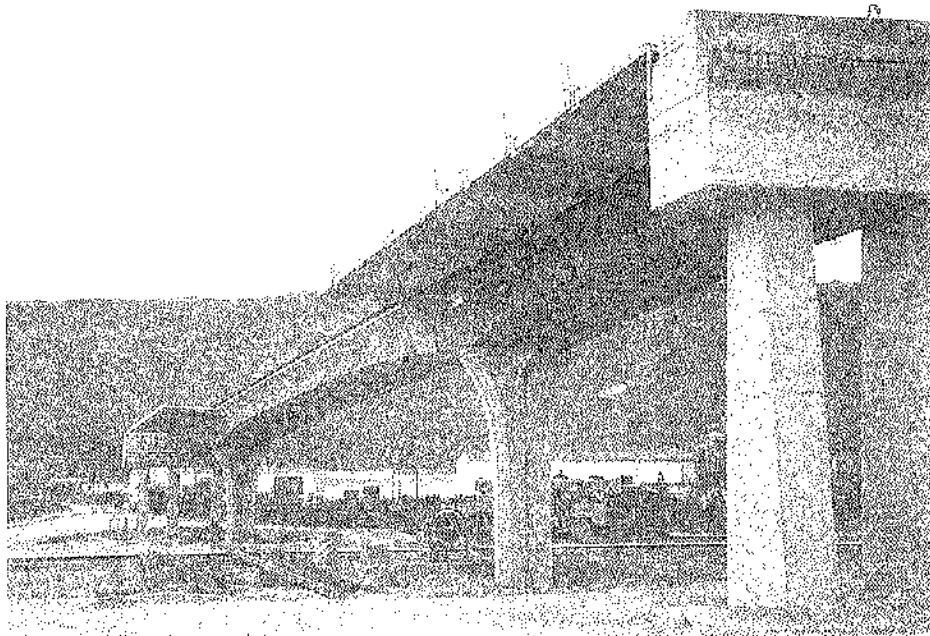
Paso superior en Autovía Pamplona-Vitoria. Prefabricación de pilas, viga parabólica continua y prelosas del tablero. Lucos: 18 - 42 - 28 m.
